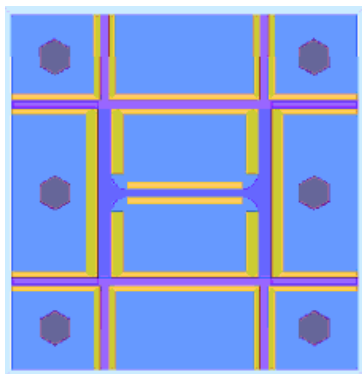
Vista superior de la placa base dels pilars del pòrtic tipus
